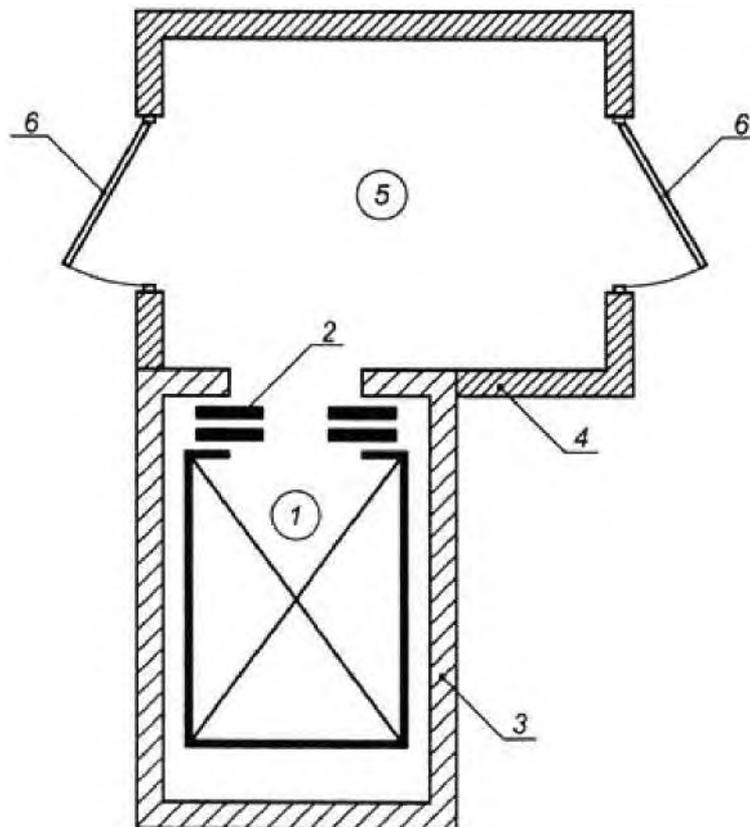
Схема размещения одиночного лифта для пожарных:
